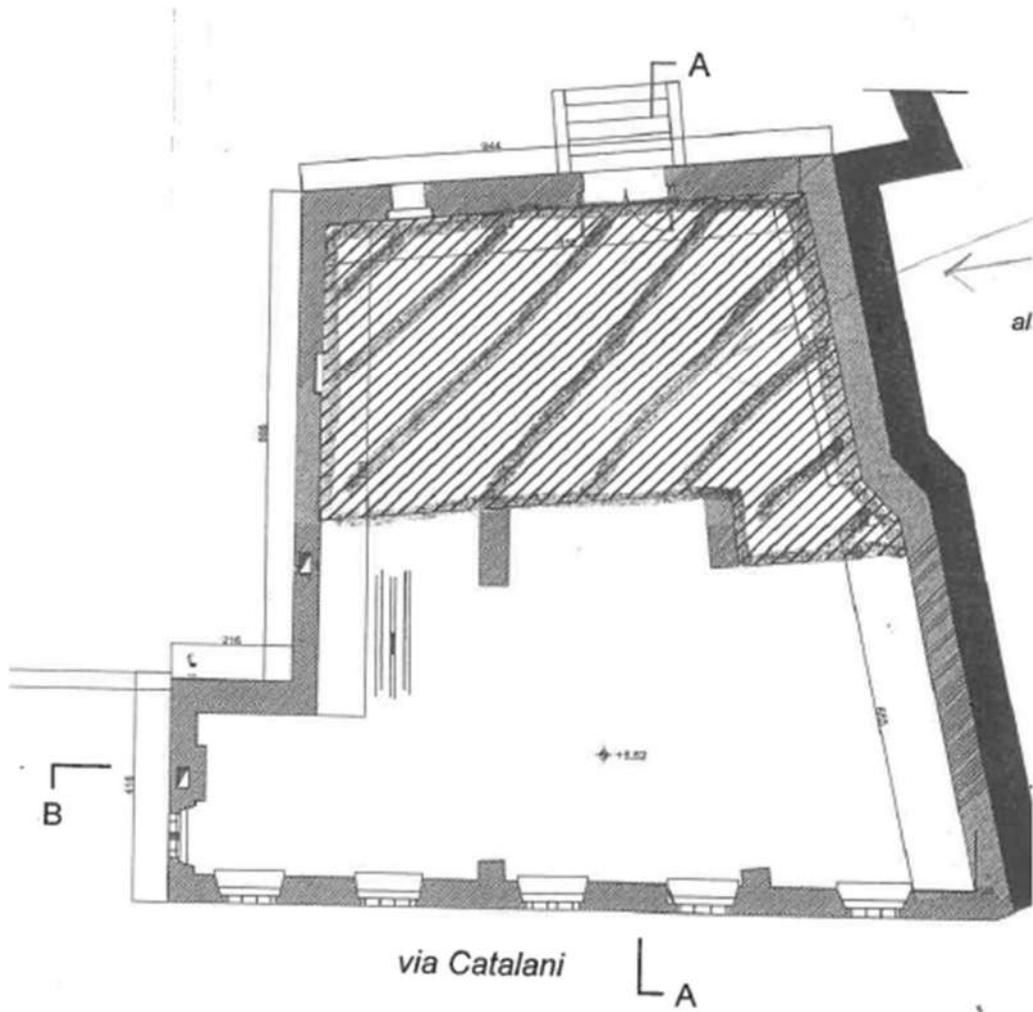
Planimetria estratta dall'Atto Rep. n. 1161/2015 – Vano da acquisire in proprietà dal Comune di Petriolo
